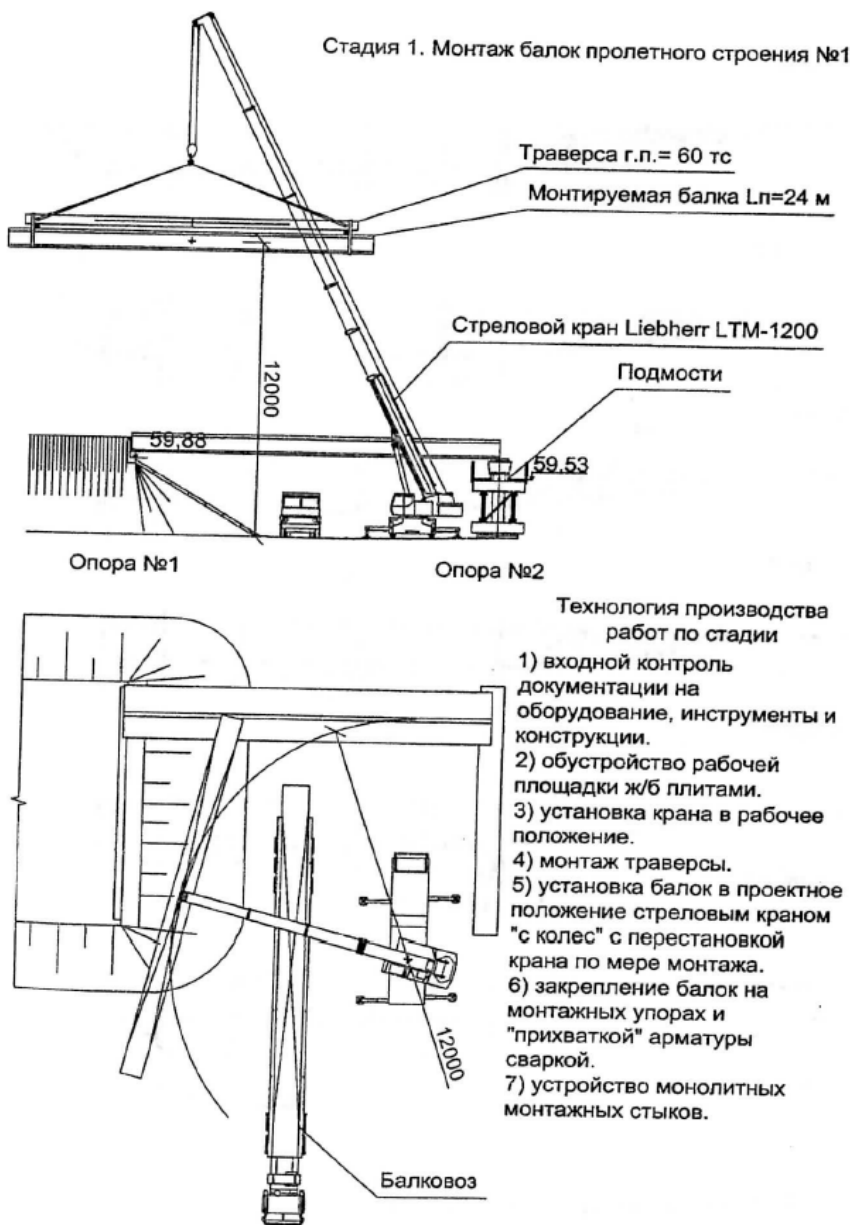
Монтаж балок пролетного строения одним краном с траверсой
